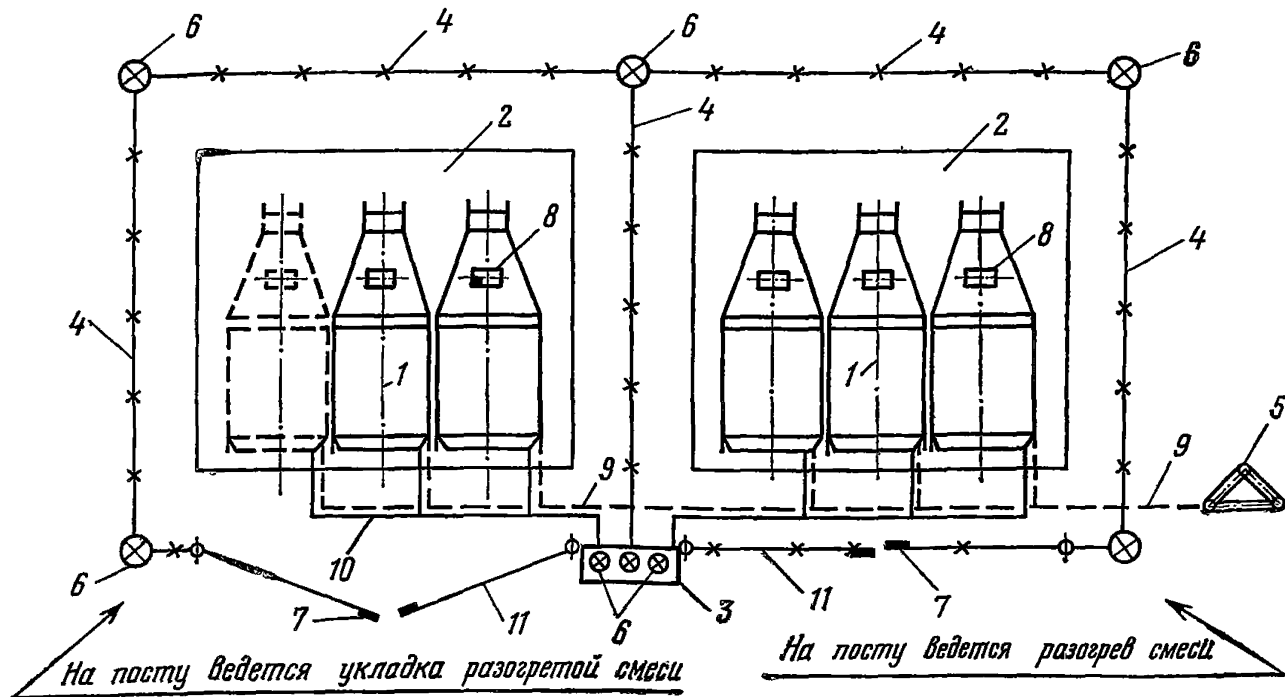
Принципиальная схема площадки для разогрева бетонной смеси
